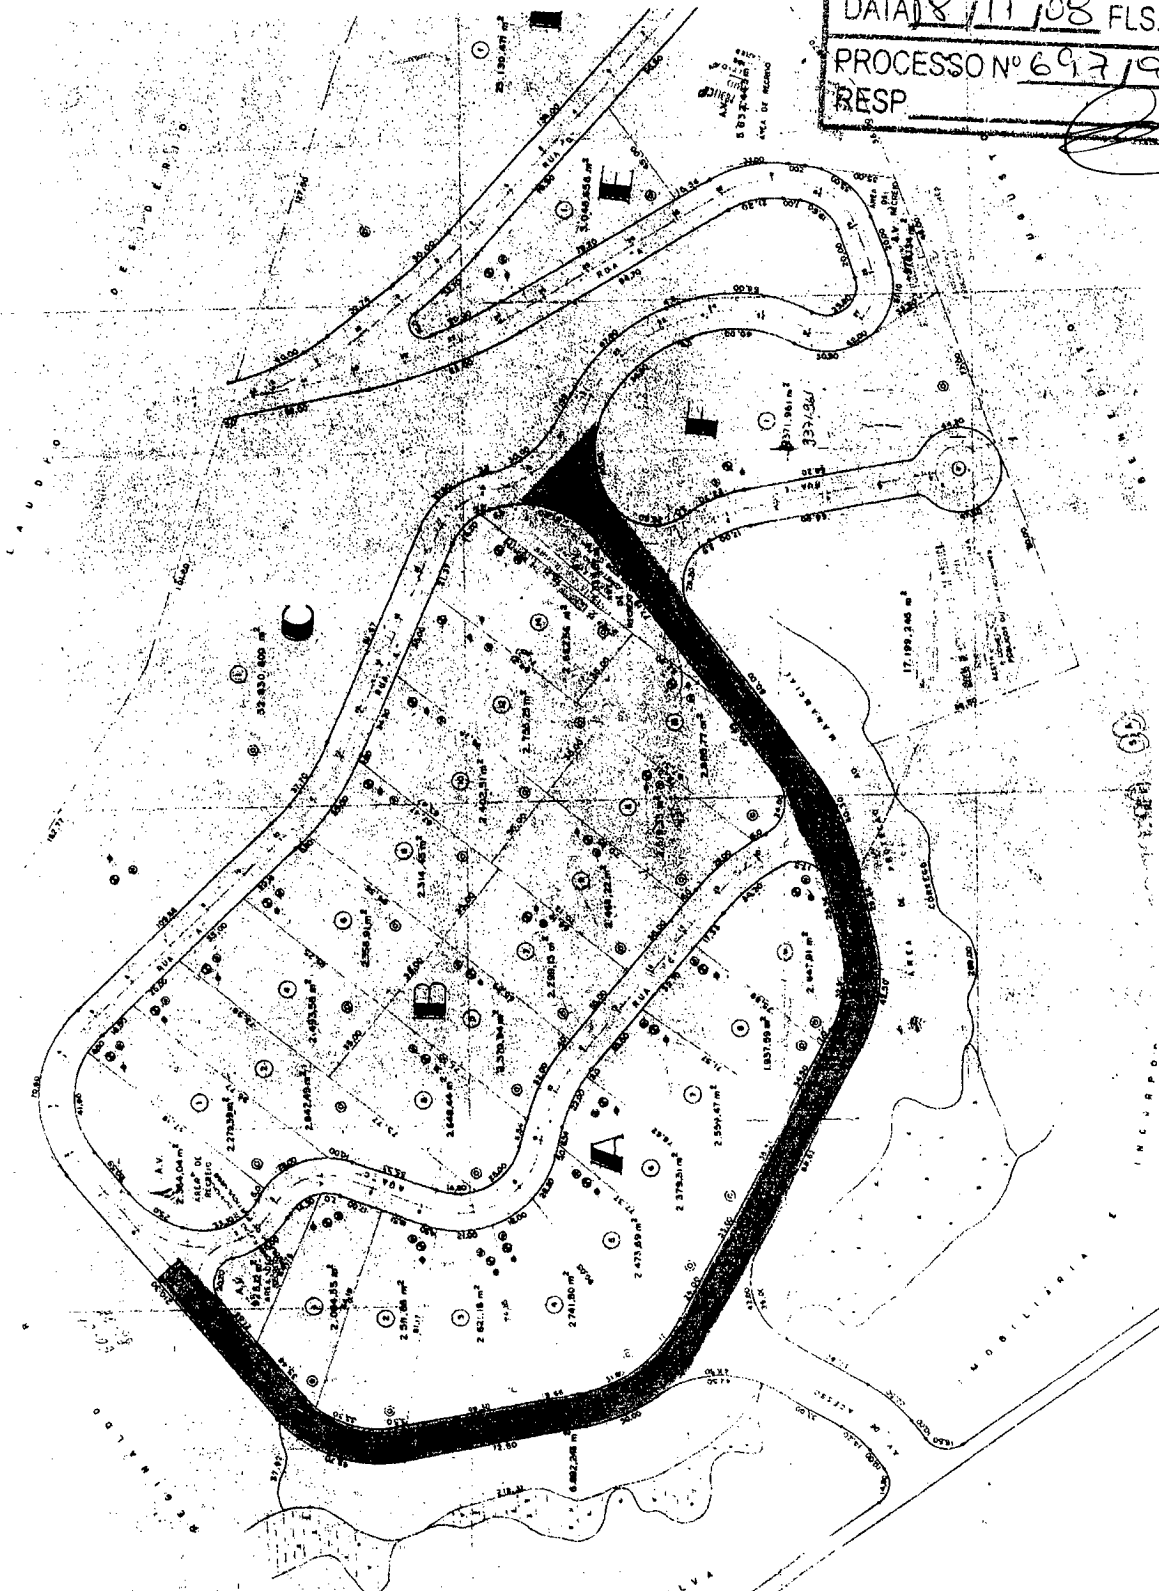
PARTE DA PLANTA DO LOTEAMENTO
